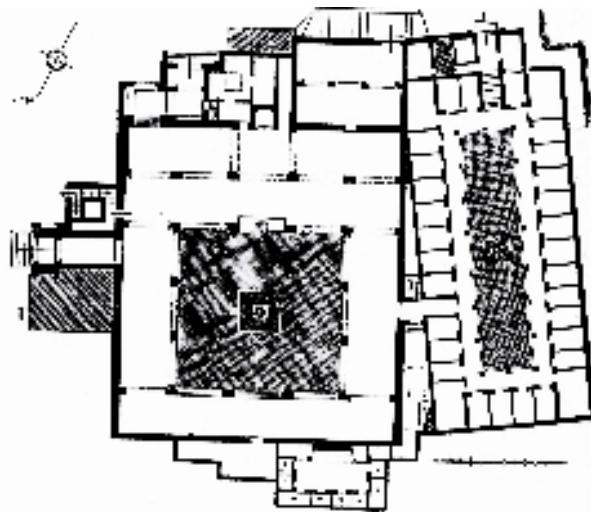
مسقط أفقى لمسجد سيدى الحلوى المرینی بتلمسان.
